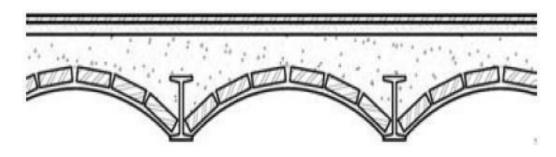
Sección forjado de revoltón con viguetas metalicas
